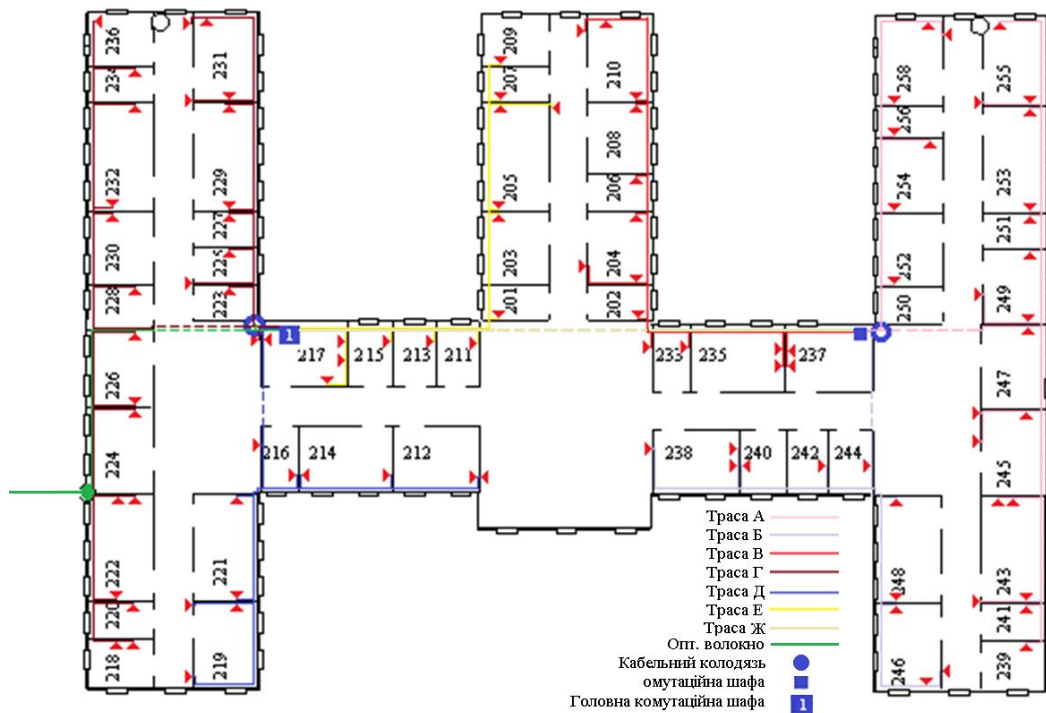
План проведення кабельних трас на першому поверсі будівлі №2
